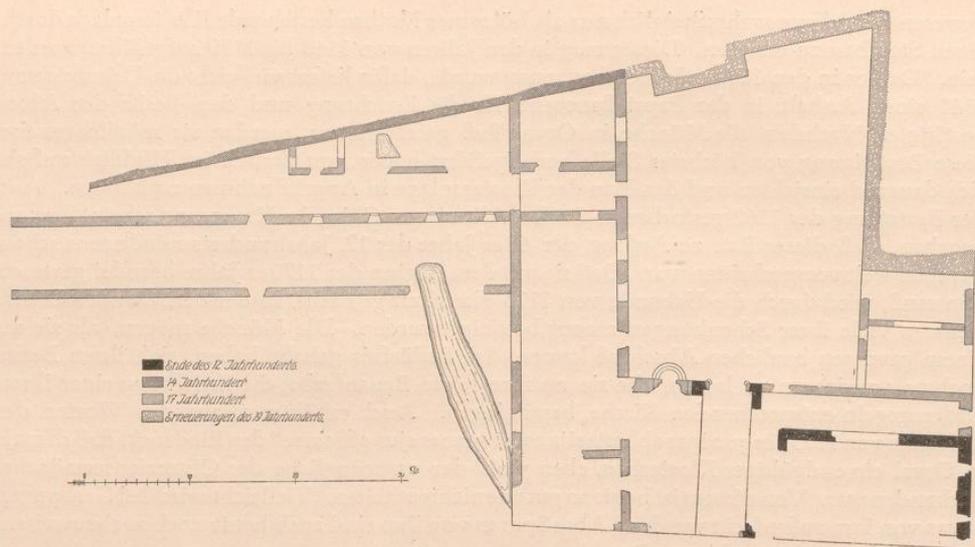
Grundriß des Eingangshofs, jetziger Zustand.
